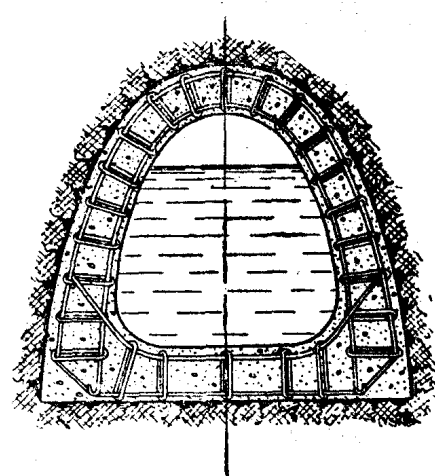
高狭轮廓并用钢筋混凝土衬砌加强的水利工程隧道截面图 (该隧道建在土质不稳定和山体压力强大的地方)
